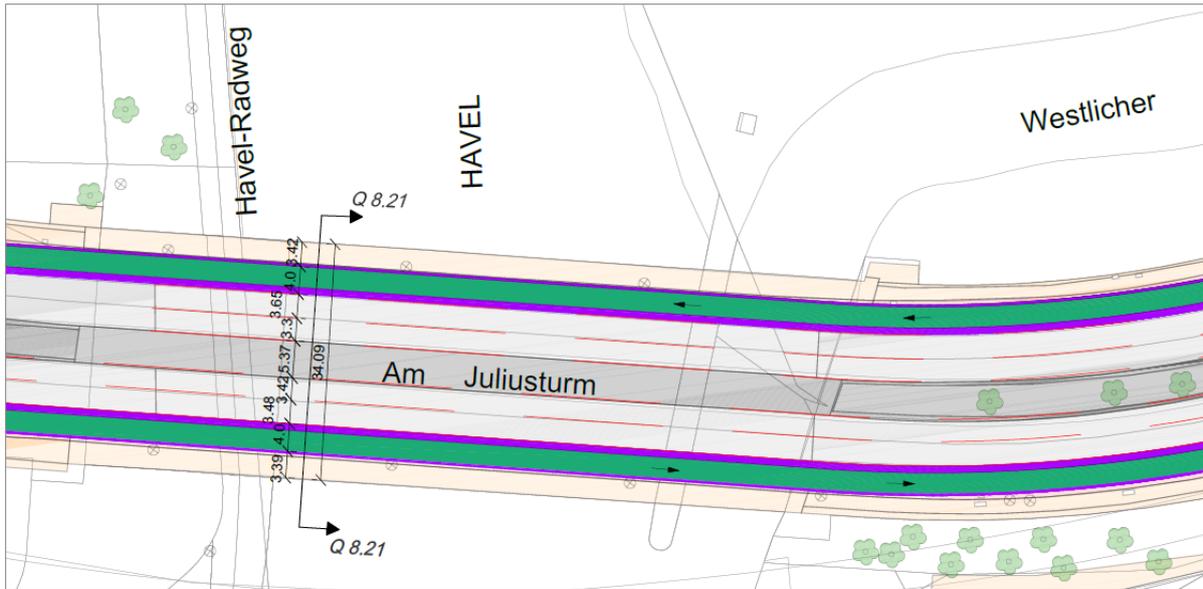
Juliussturmbrücke – Ausschnitt Lageplan
